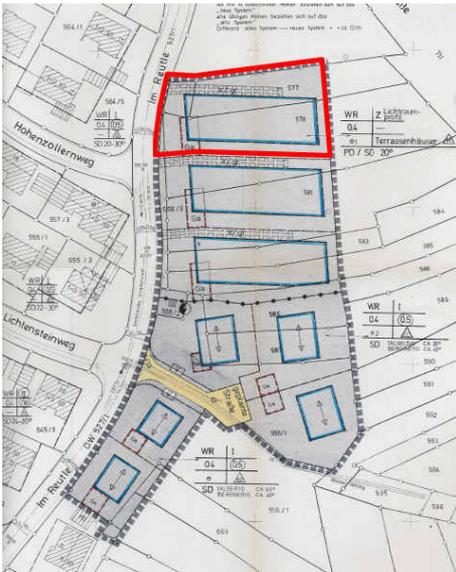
Ausschnitt des Bebauungsplans "Reutle – Erweiterung II" (1983) mit überschneidendem Geltungsbereich (rote Markierung)
